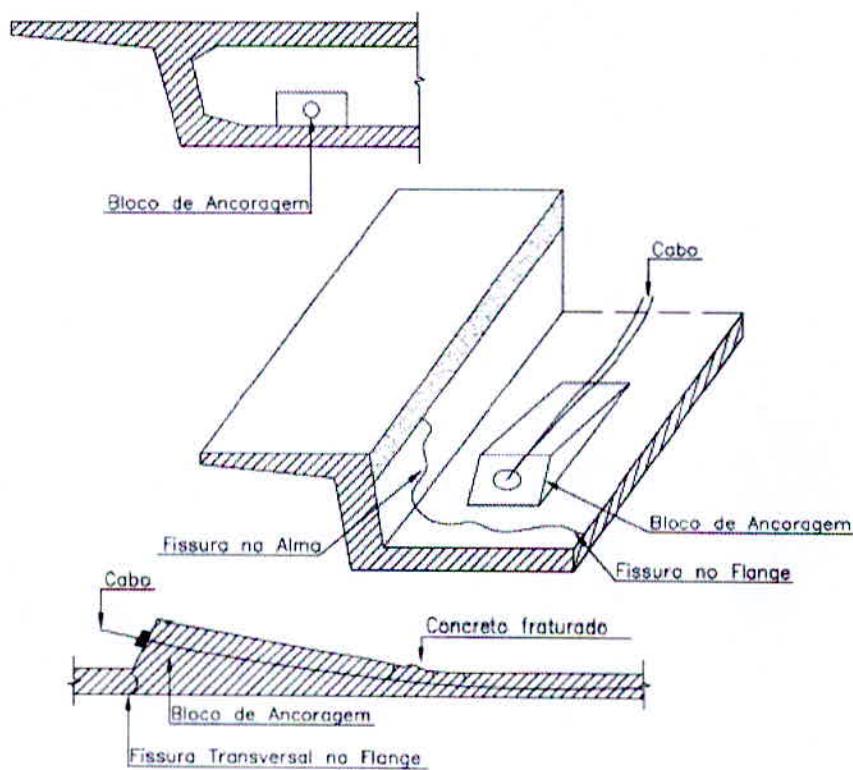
Fissuras nas vigas de concreto protendido, blocos de ancoragem.
